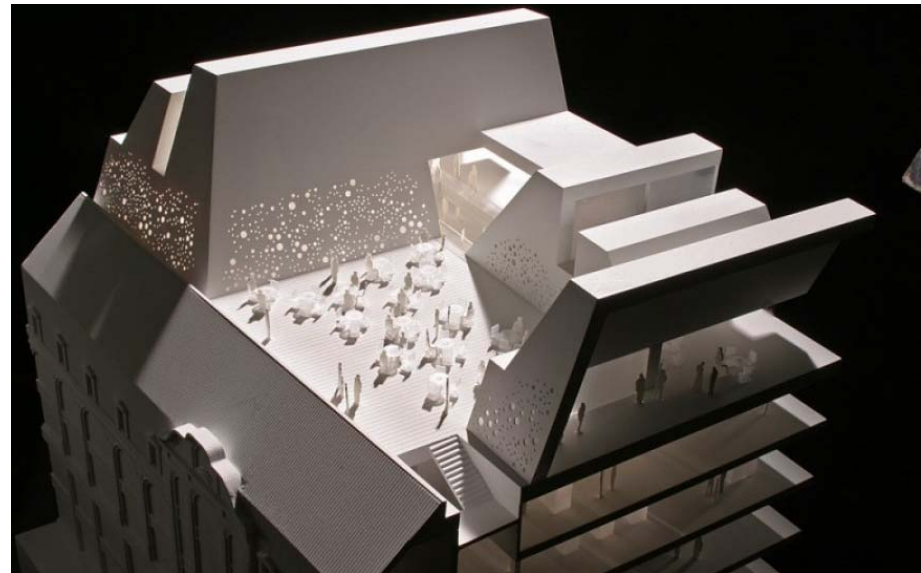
Kaufhaus Kastner & Öhler, Graz – Modellaufnahme der Dachterrasse (siehe Bild oben rechts), Grundriss und Schnitt (siehe unten)
